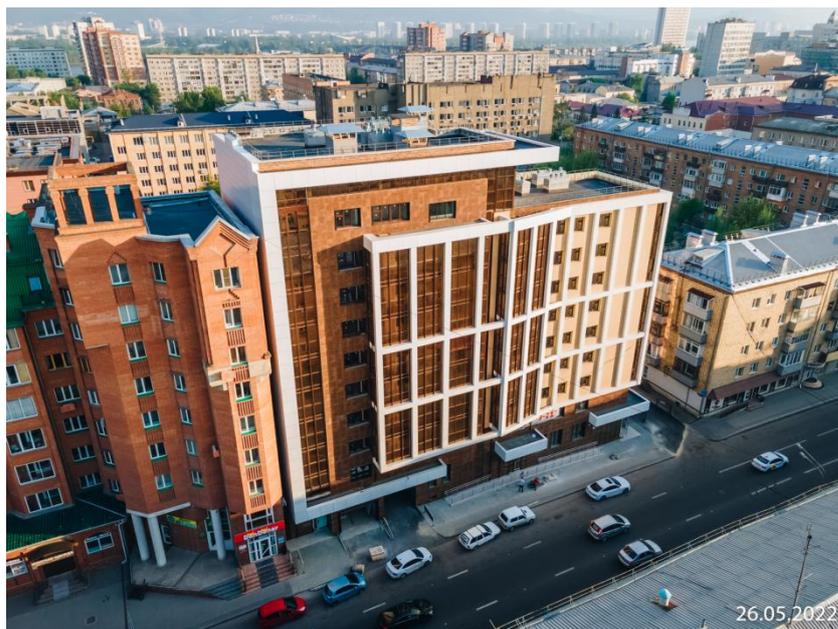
ЖД по ул.Ленина 25 г. Красноярск, с вентилируемым фасадом
